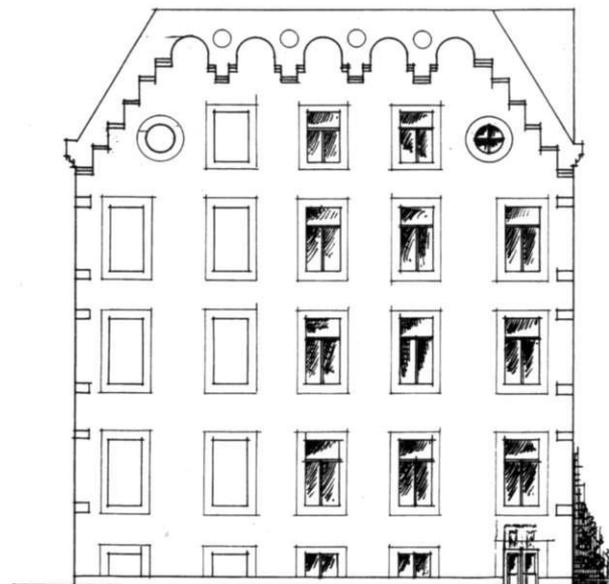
Fassade am Bauwich Gerhart-Hauptmann-Straße 62
